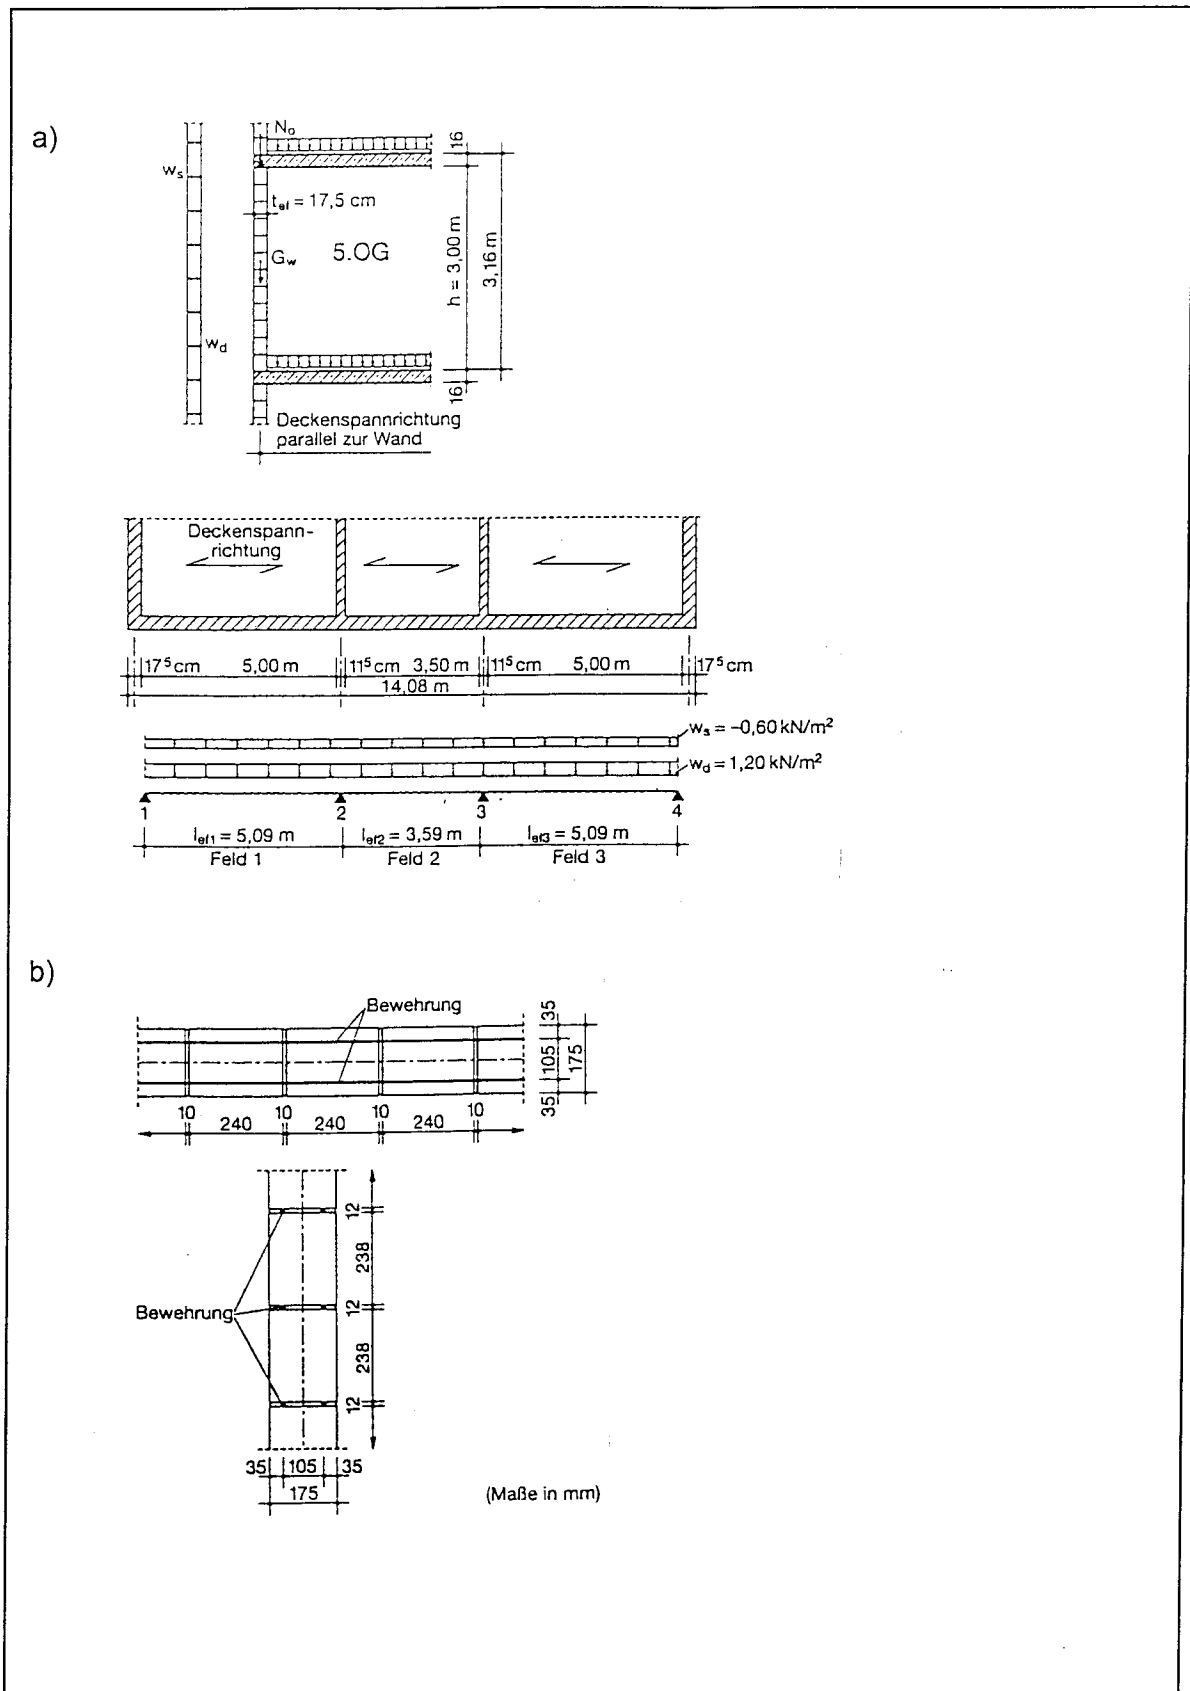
a) Schnitt, Grundriss (Geometrie), System und Belastung
